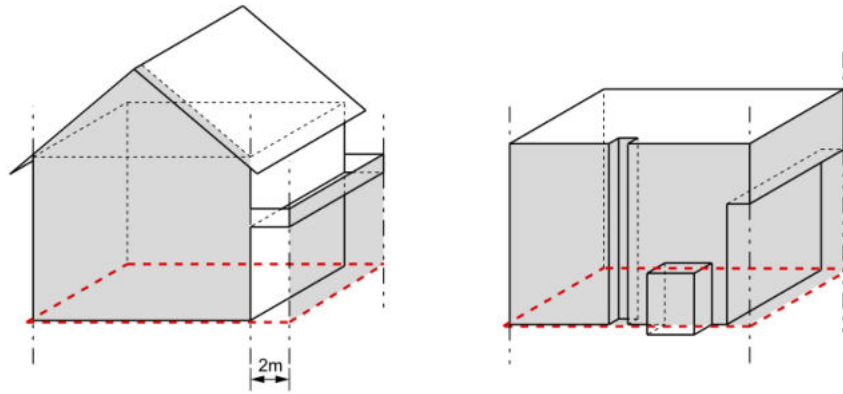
Fassadenflucht und Fassadenlinie (§ 36 und § 37)
